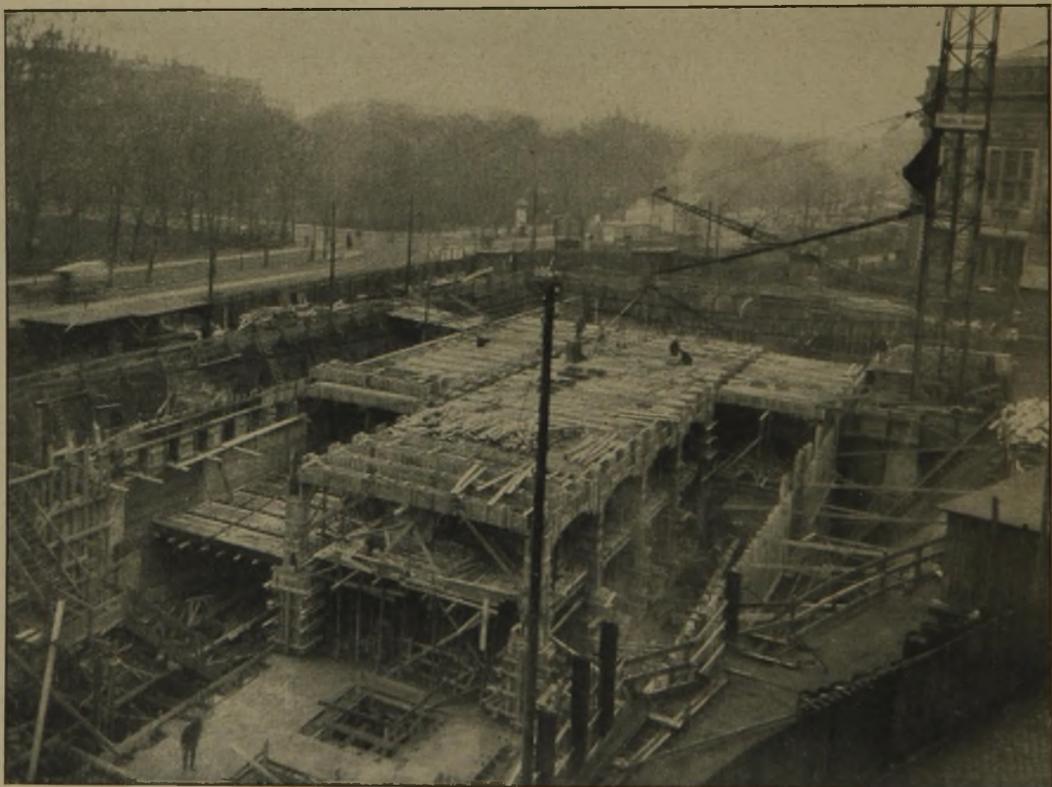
Blick in die Baugrube während der Ausführung des Eisenbeton-Aufbaues. (Rechts im Hintergrund das Panorama.)
